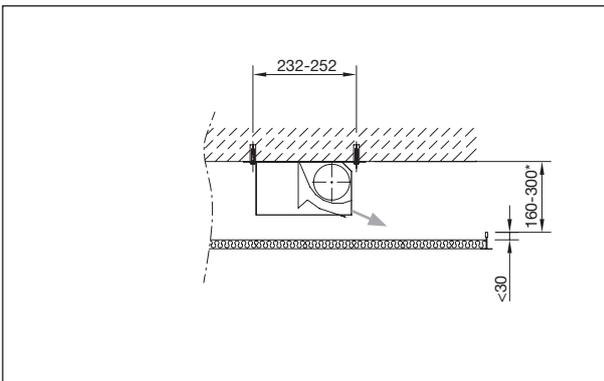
Abmessungen für die Montage an einem Deckenträger. Hängende Inselmontage.
